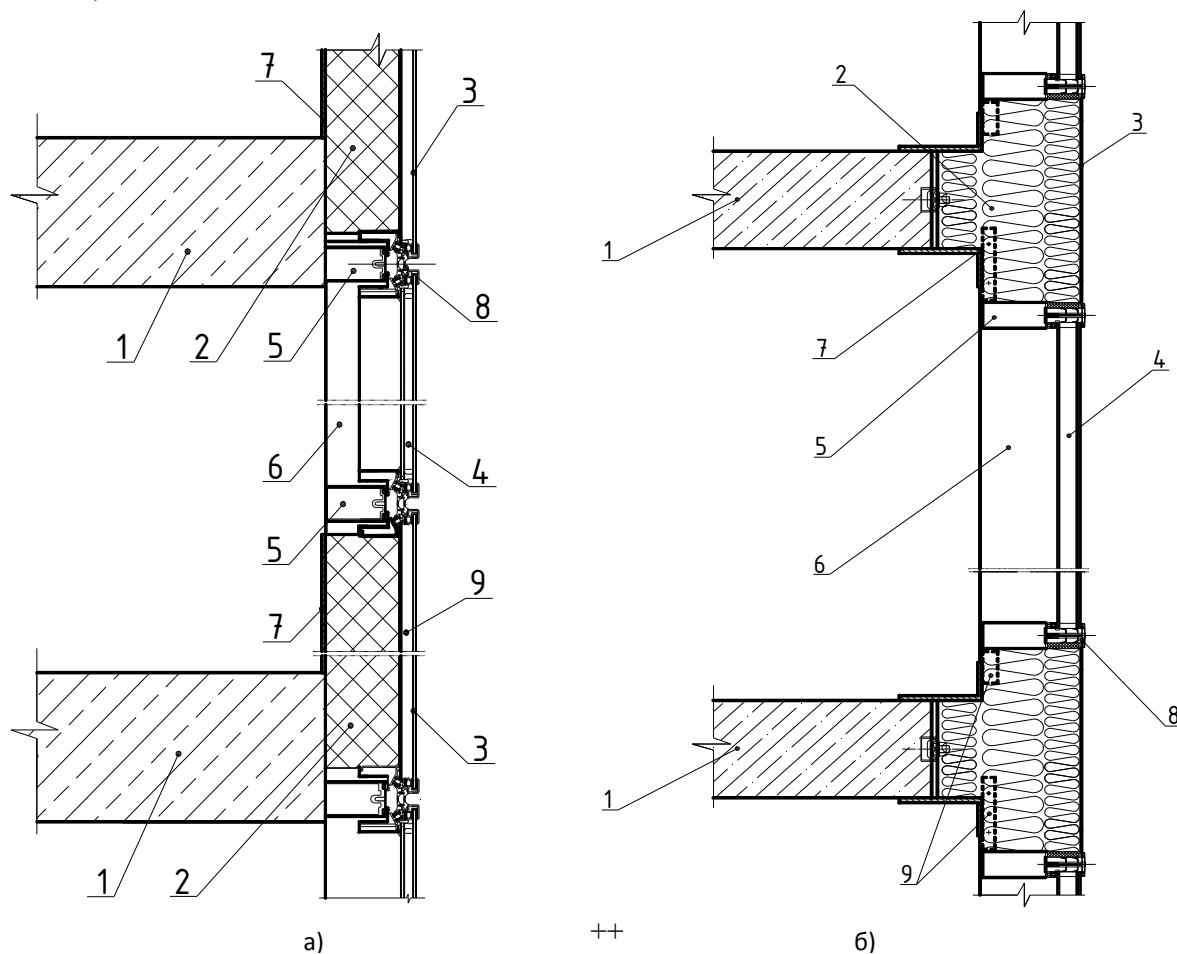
Конструктивна схема зовнішніх стін з комбінованим світлопрозорим фасадом (а) та з суцільним світлопрозорим фасадом з теплоізоляцією плит перекриттів (б)
